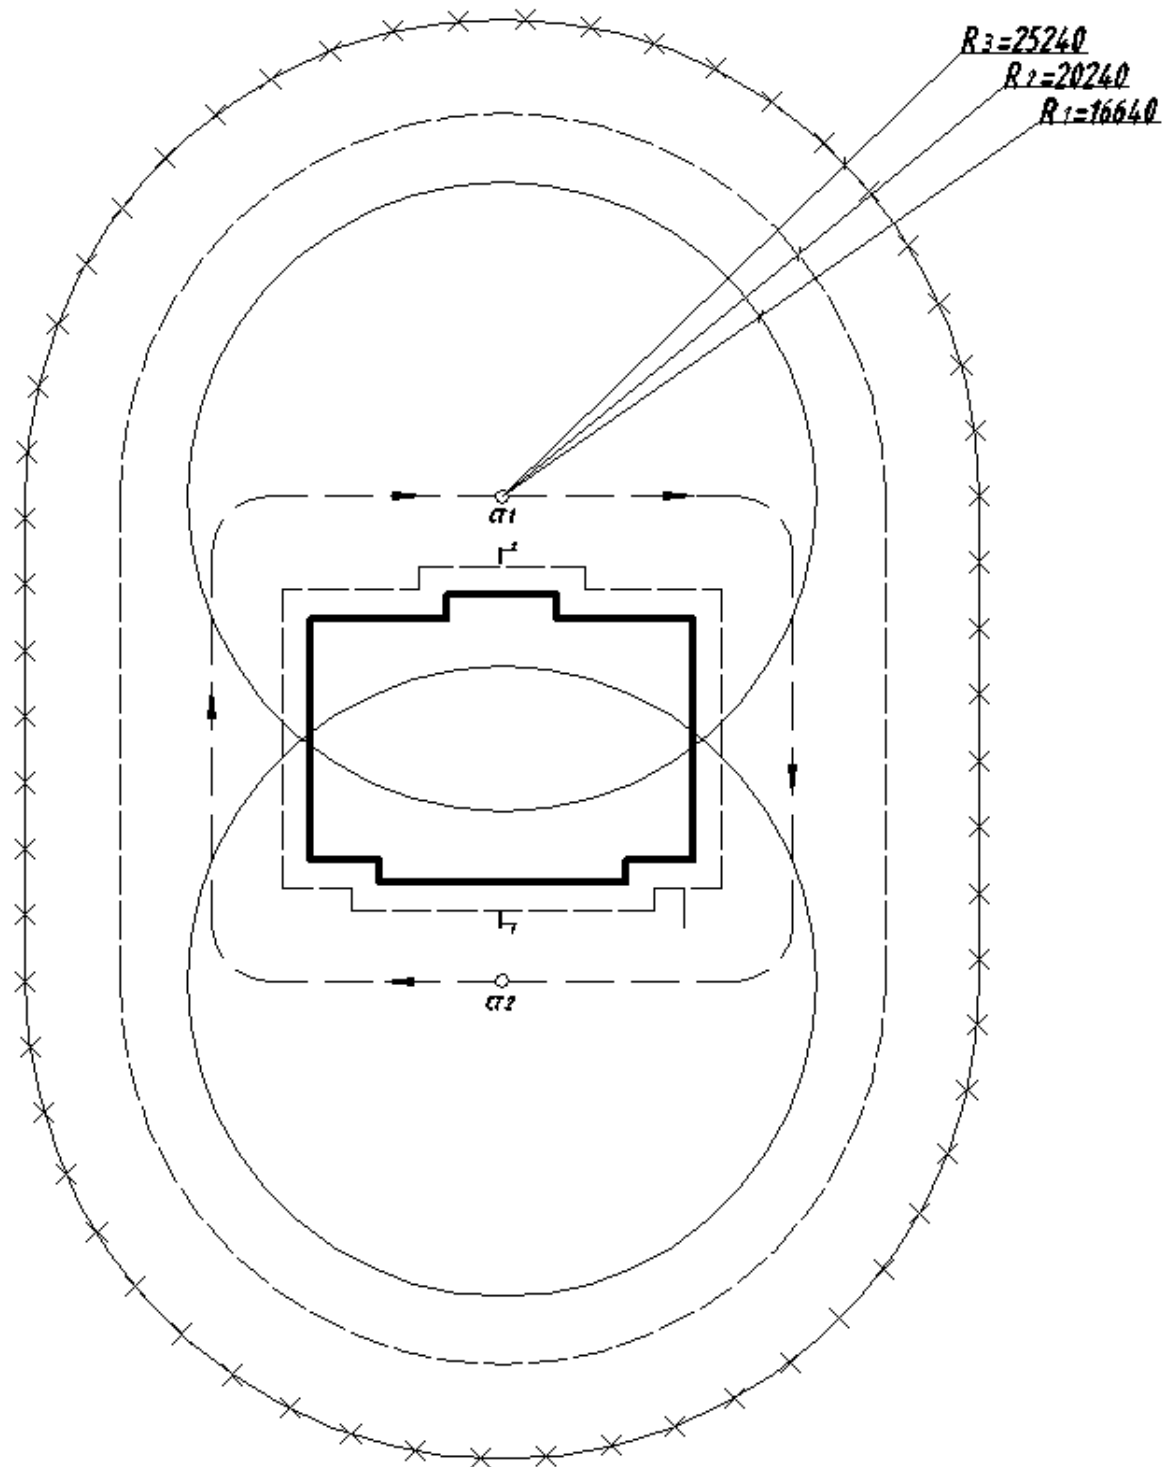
Привязка монтажного крана на стройгенплане и определение опасных зон по технике безопасности
